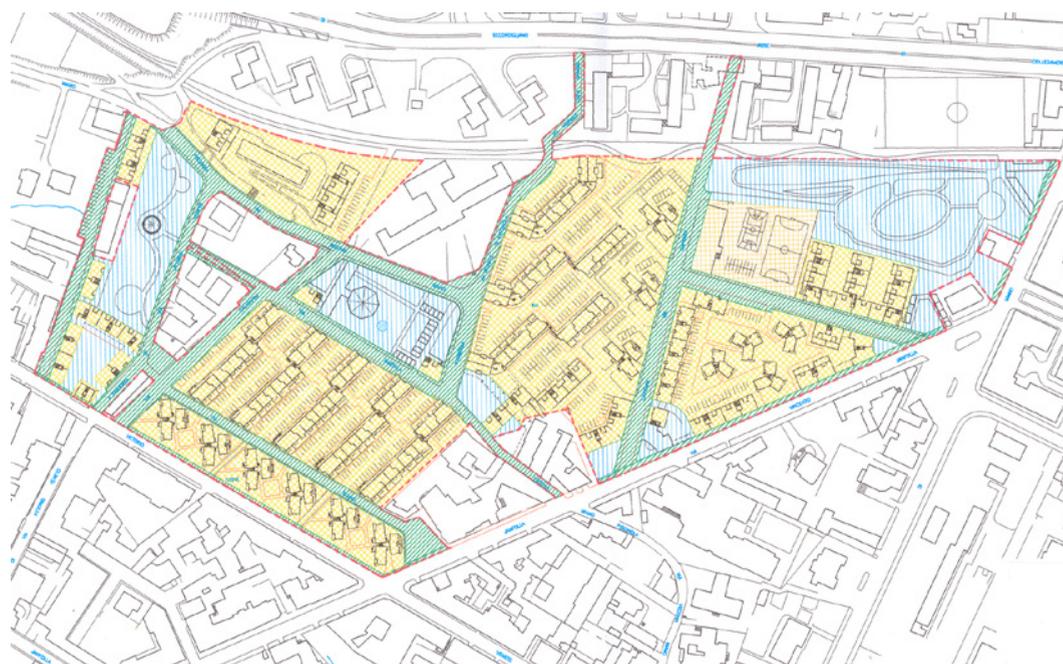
Rione S. Gaetano, planimetria ipotesi progettuale di rigenerazione ri-
